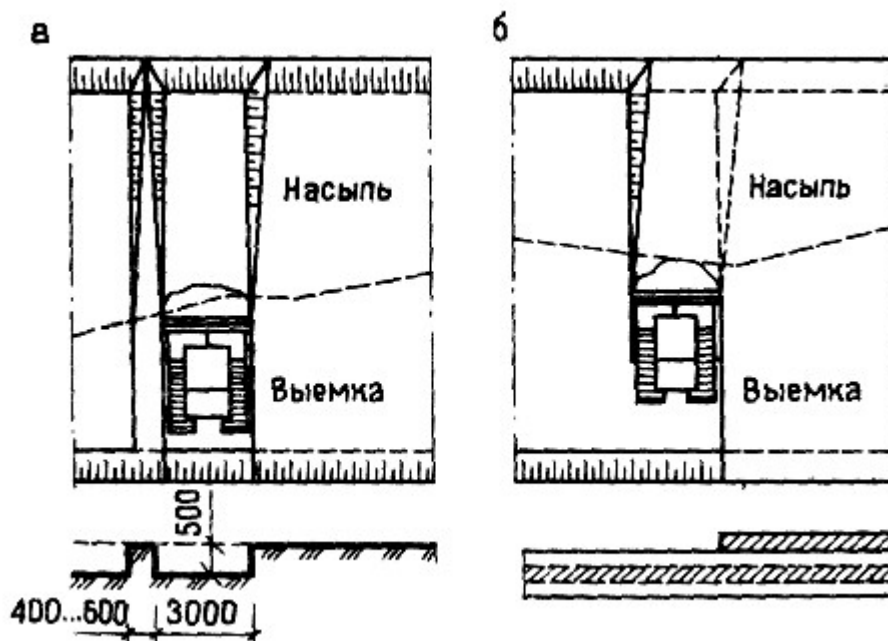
Схема разработки грунта бульдозерами траншейным (а) и послойным (б).
